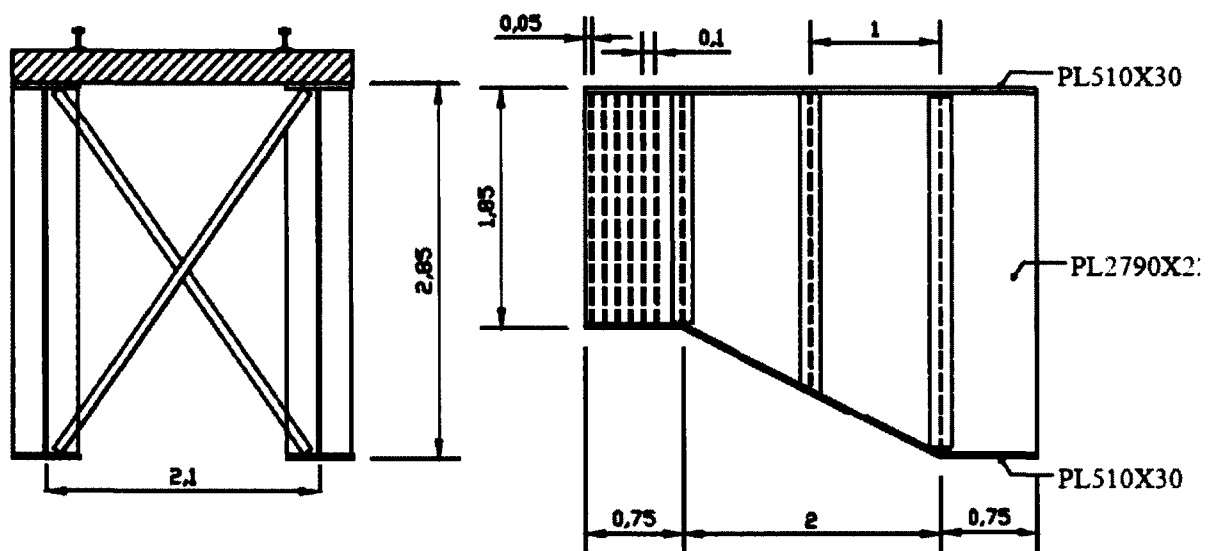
Pont bi-poutres - Section transversale et élévation - Section C-2
